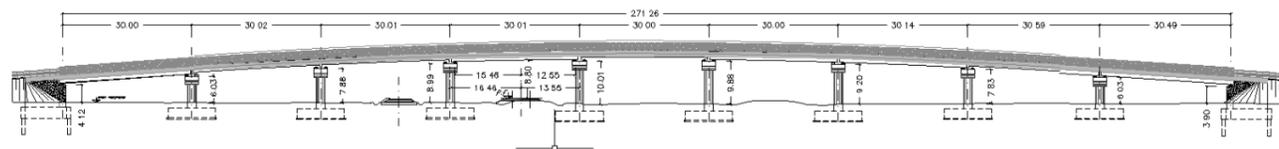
Cavalcaferrovia IV01 - Prospetto
